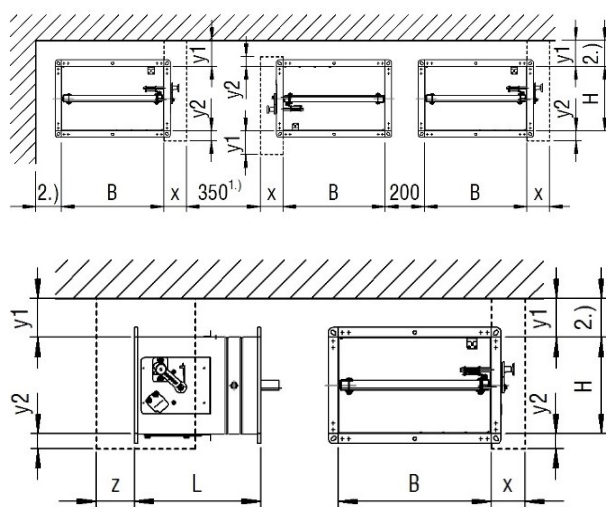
Distances minimales aux murs, plafonds et entre les BKP-EN
